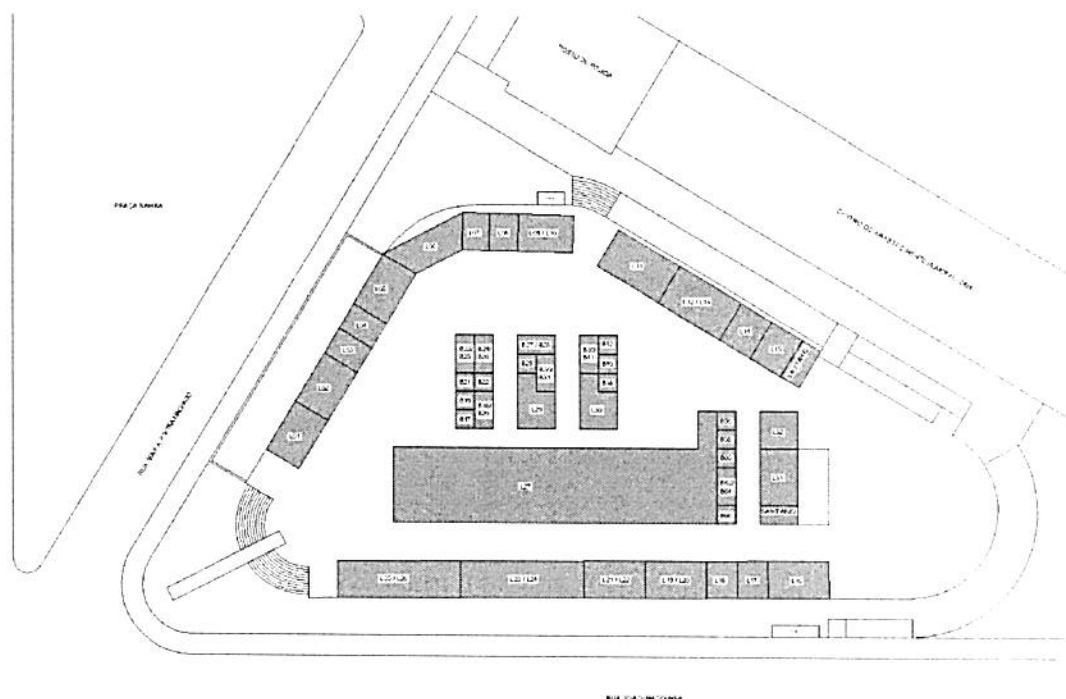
Implantação atual da Feira Coberta do Bairro São Paulo
